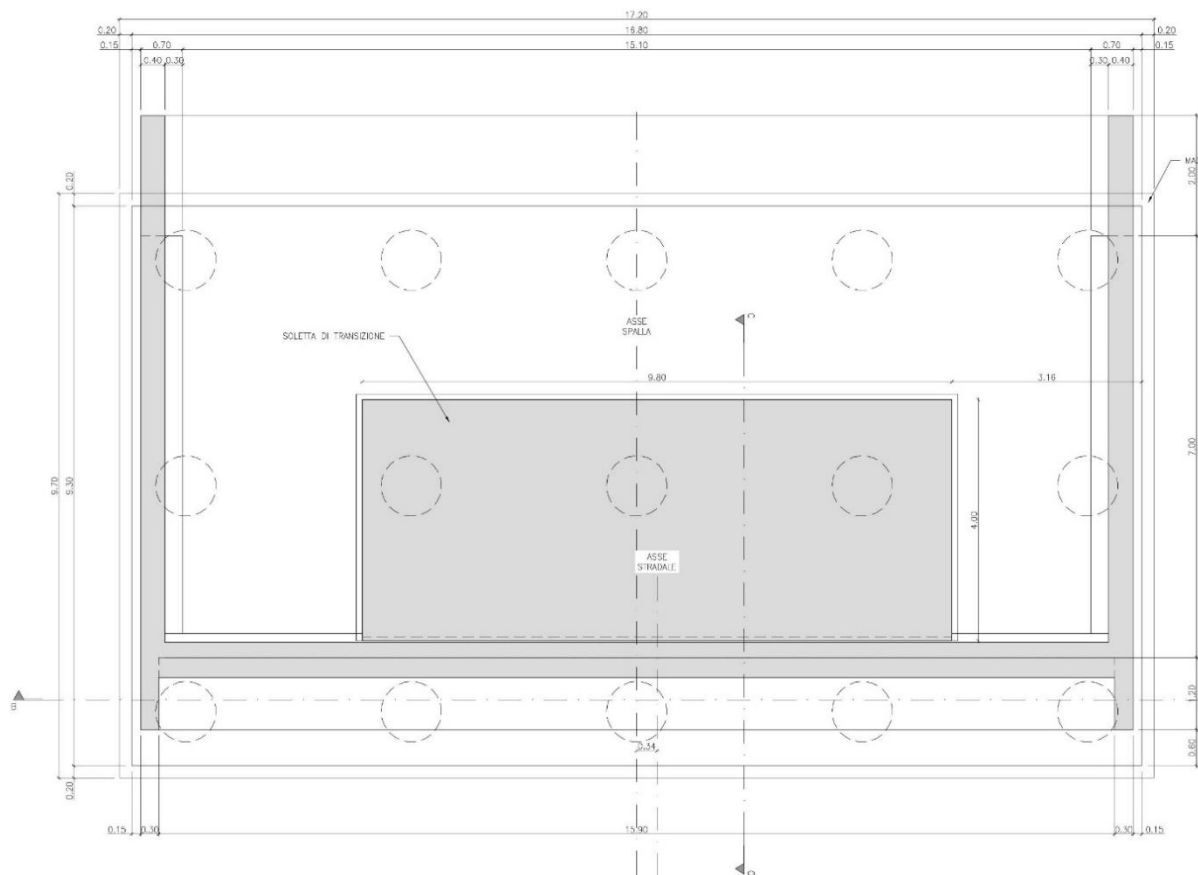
Sezione Trasversale Carpenterie Spalla
